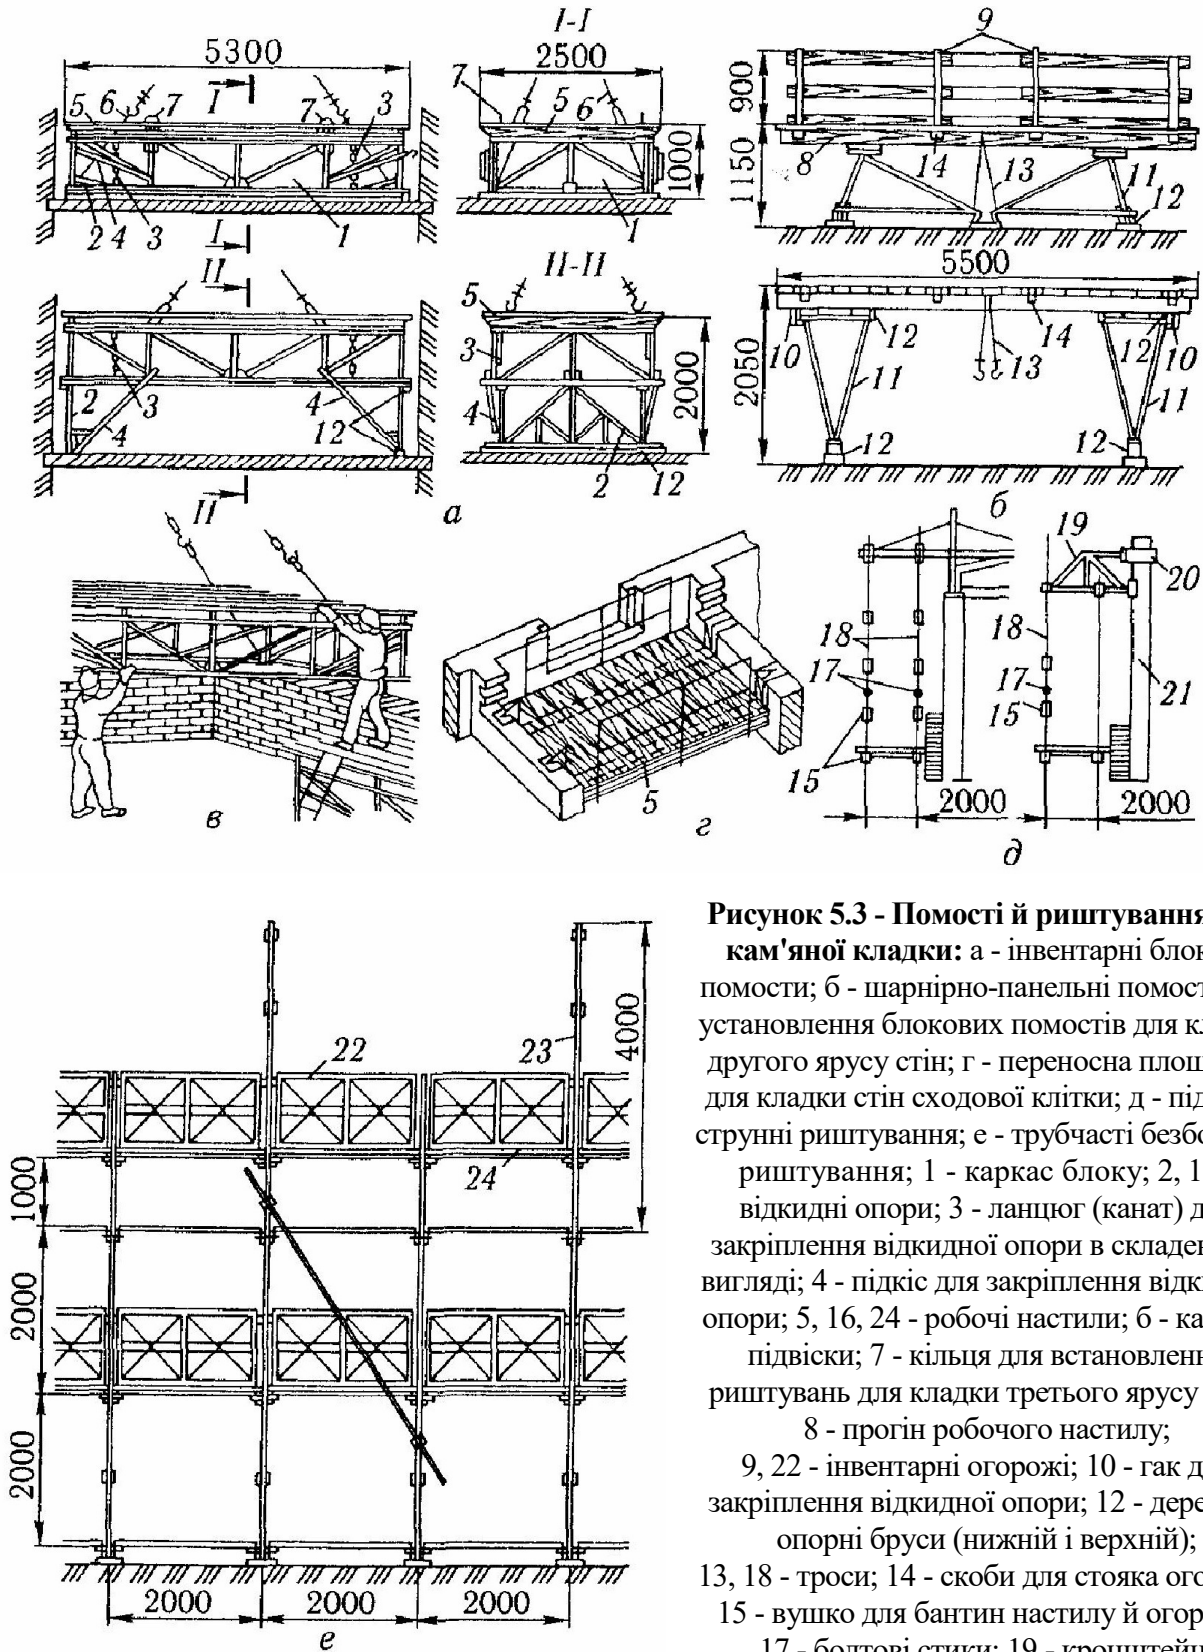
Помості й риштування для кам'яної кладки: а - інвентарні блокові помості; б - шарнірно-панельні помості; в - установлення блокових помостів для кладки другого ярусу стін; г - переносна площадка для кладки стін сходової клітки; д - підвісні струнні риштування; е - трубчасті безболтові риштування; 1 - каркас блоку; 2, 11 - відкидні опори; 3 - ланцюг (канат) для закріплення відкидної опори в складеному вигляді; 4 - підкіс для закріплення відкидної опори; 5, 16, 24 - робочі настили; б - канатні підвіски; 7 - кільця для встановлення риштувань для кладки третього ярусу стін; 8 - прогін робочого настилу; 9, 22 - інвентарні огорожі; 10 - гак для закріплення відкидної опори; 12 - дерев'яні опорні бруси (нижній і верхній); 13, 18 - троси; 14 - скоби для стояка огорожі; 15 - вушко для бантин настилу й огорожі; 17 - болтові стики; 19 - кронштейн; 20 - хомут; 21 - колона; 23 - стояк
